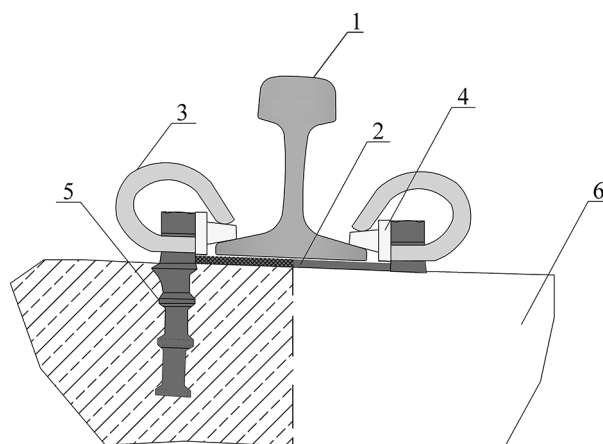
Общий вид рельсового промежуточного скрепления СБ-3: 1 — рельс; 2 — прокладка упругая; 3 — упругая клемма; 4 — изолирующая втулка; 5 — анкер; 6 — шпала
